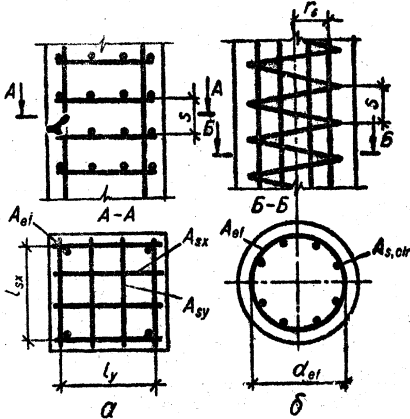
Стиснуті елементи з непрямым армуванням: а – зварними сітками;
